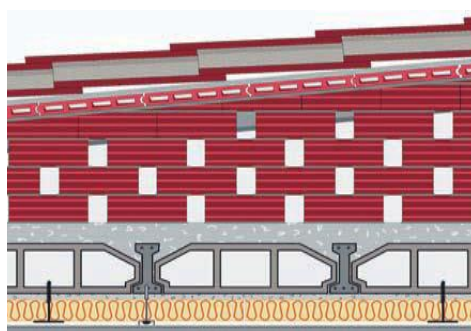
Cubierta inclinada sobre tabiquillos. Aislamiento por el interior.
